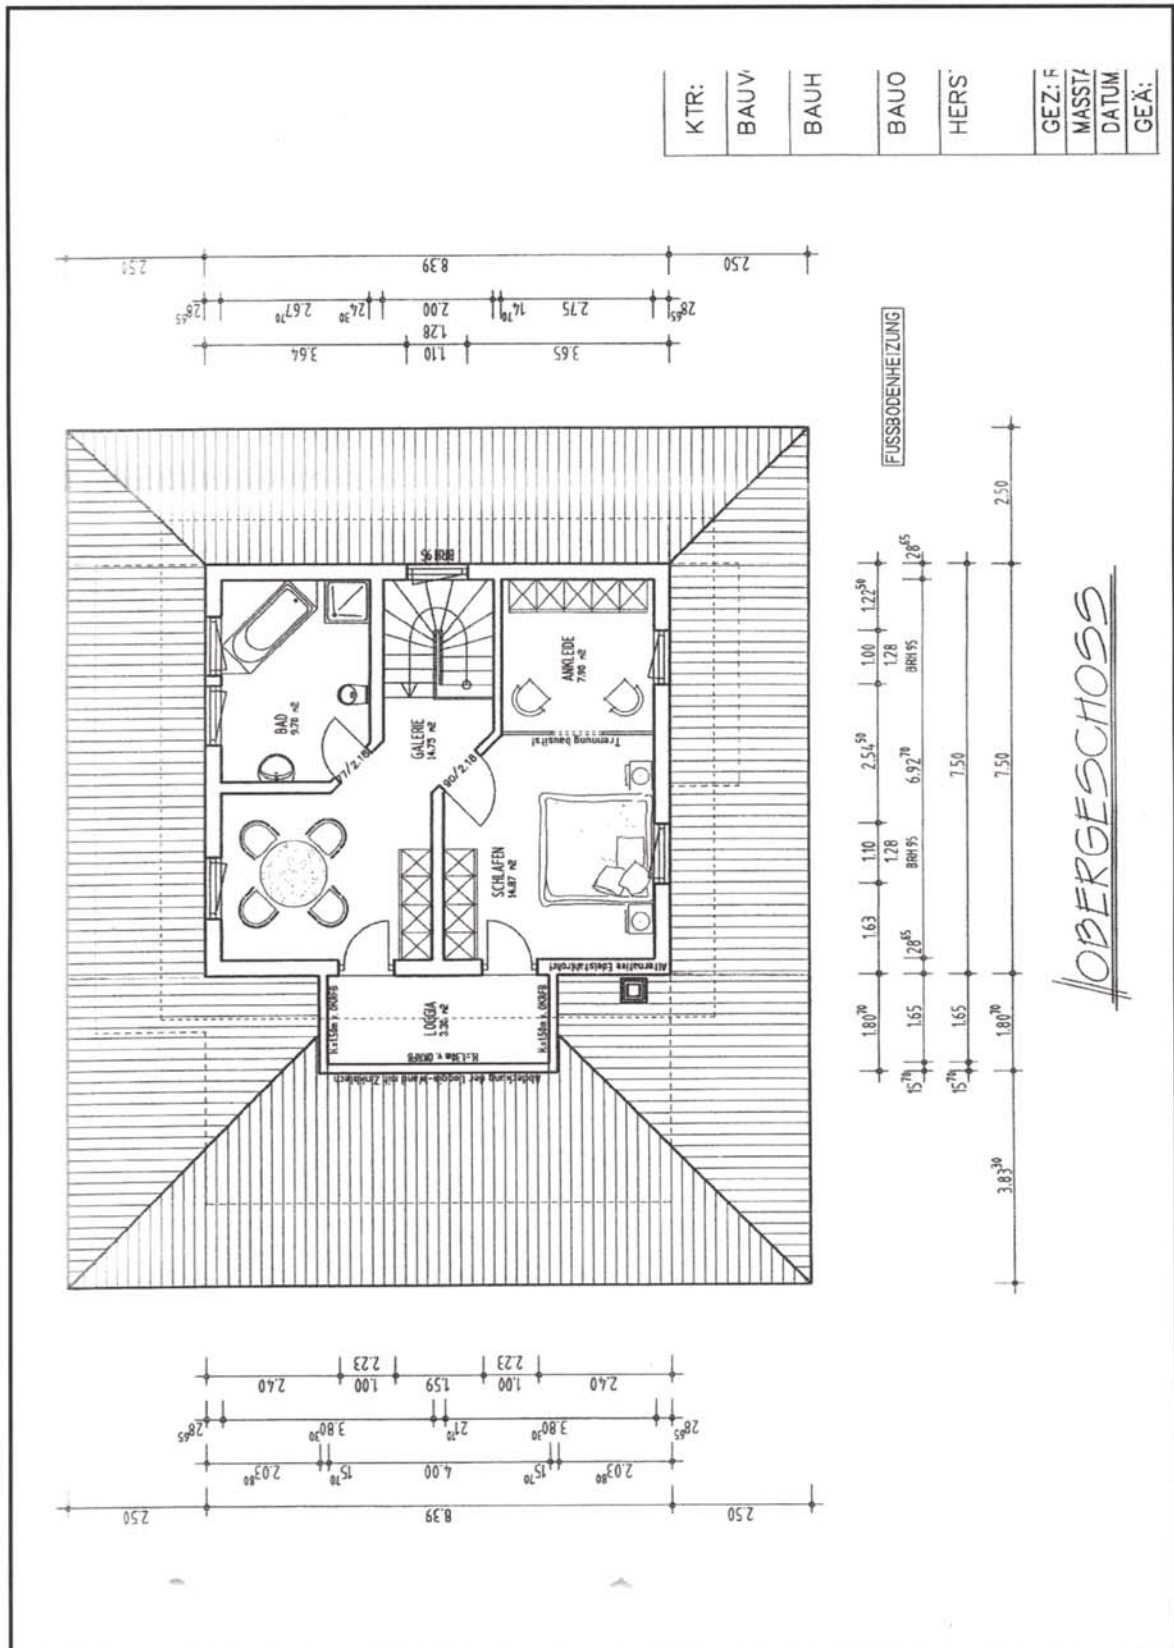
Grundrissplan (eingesannt)
